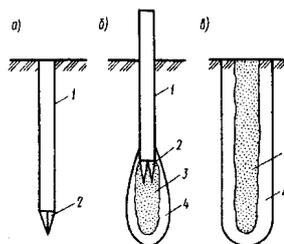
Схема устройства песчаных свай: а – погружение обсадной трубы; б – извлечение обсадной трубы и засыпка скважины песком; в – схема песчаной сваи; 1 – обсадная труба; 2 – самораскрывающийся наконечник; 3 – песчаная свая; 4 – зона уплотнения
